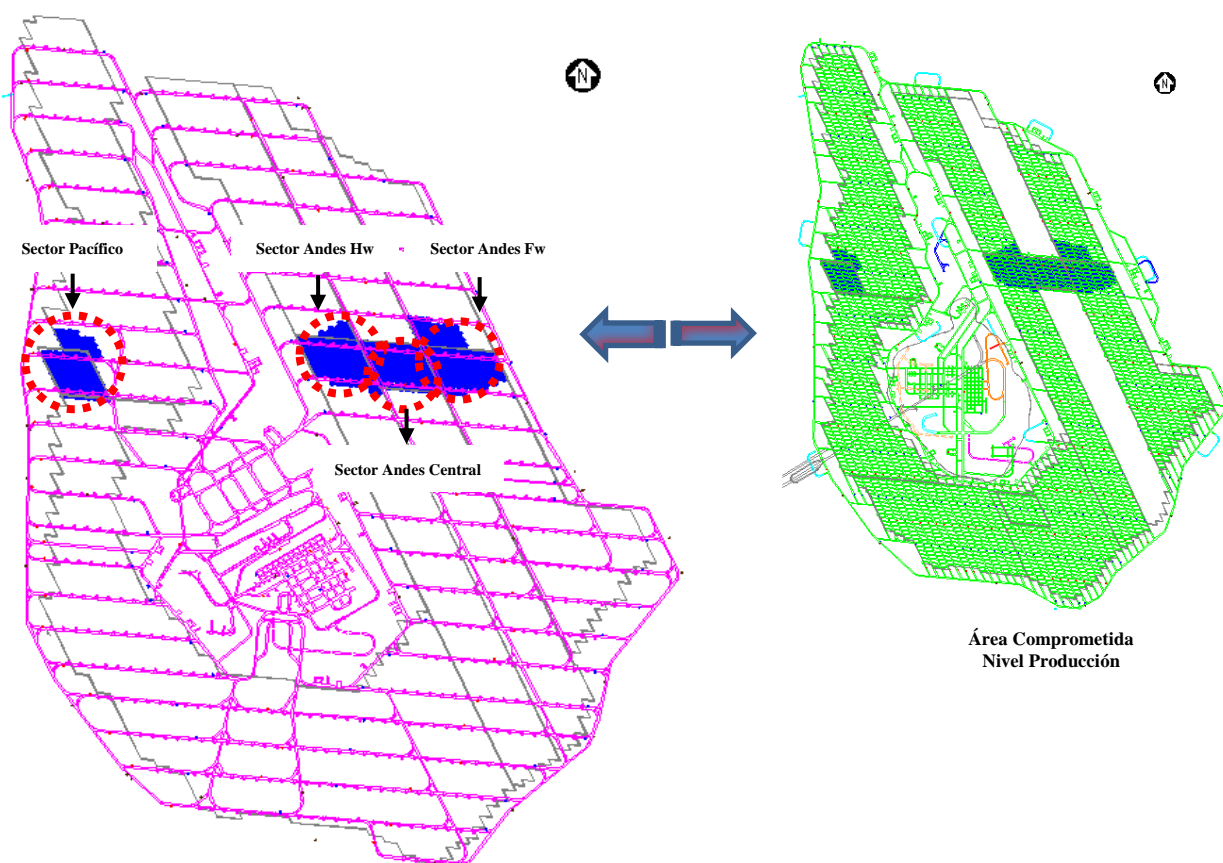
Layout Nivel de Transporte Intermedio.
